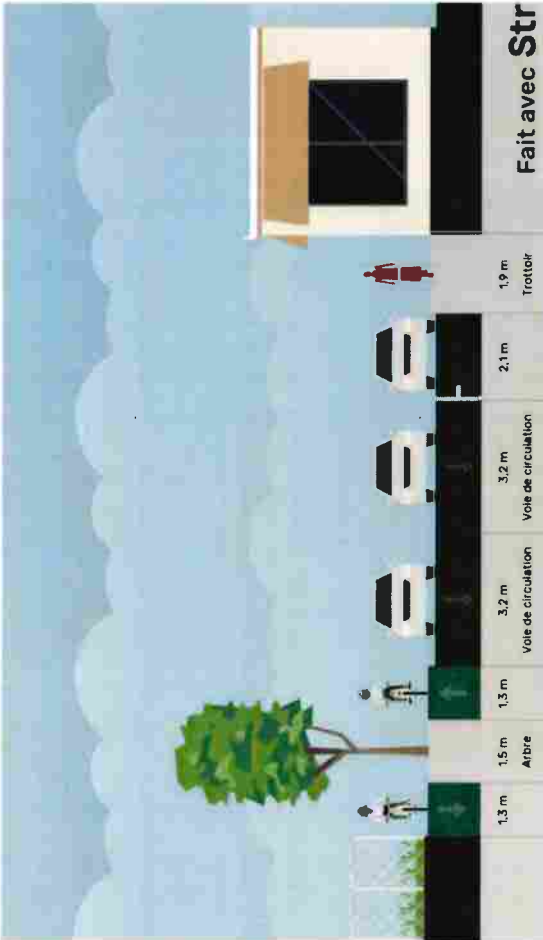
COUPE EN TRAVERS DU SECTEUR HERRIOT AVEC STATIONNEMENT
